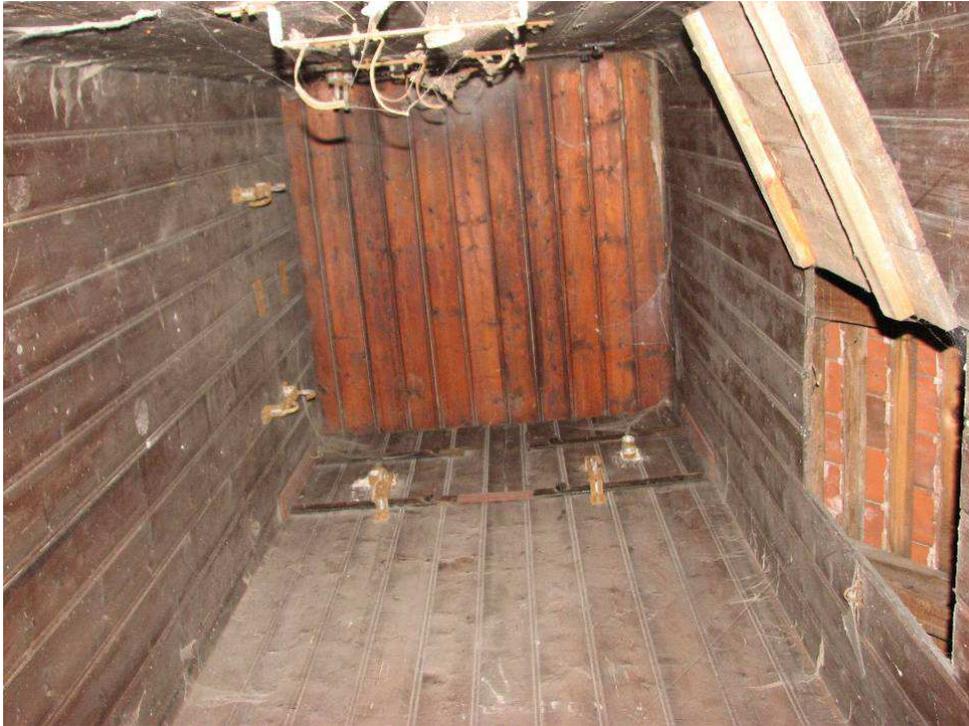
Verkleidung im Inneren des Dachaufbaus des Trafohauses
